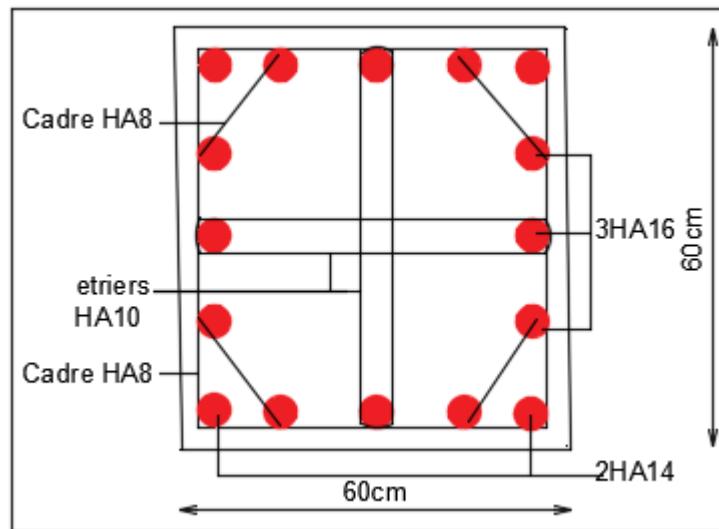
Schéma de ferrailage des poteaux Sous-sol + rdc
